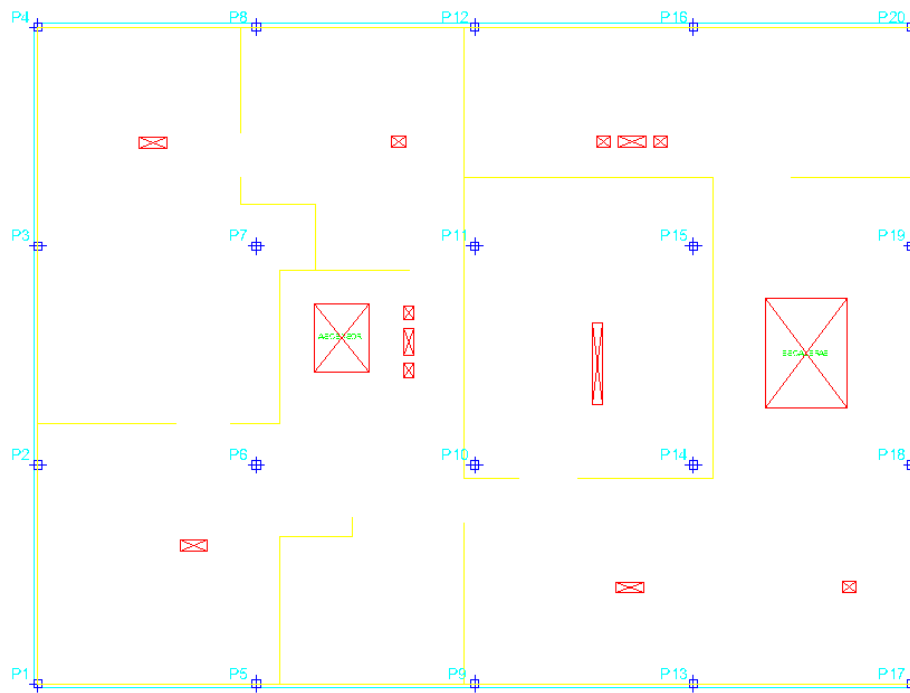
Vista en planta del replanteo en planta tipo
